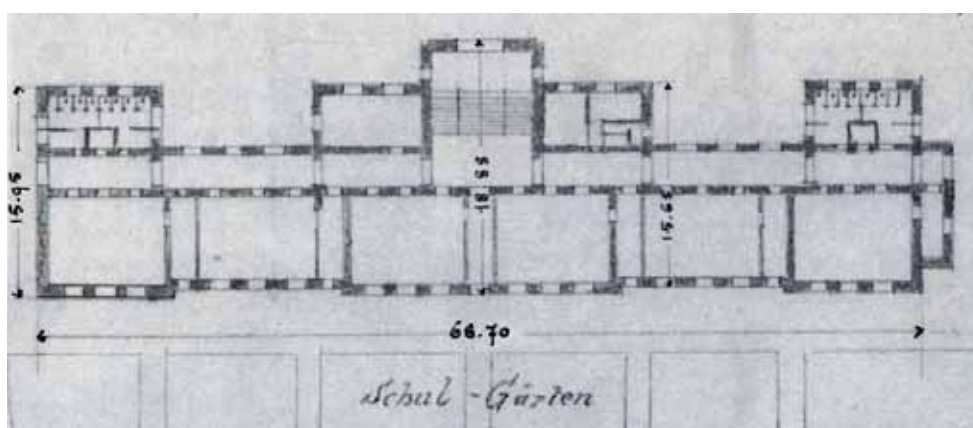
Grundriss Primarschulhaus Länggasse, Bern, 1891, Grundriss Erdgeschoss
